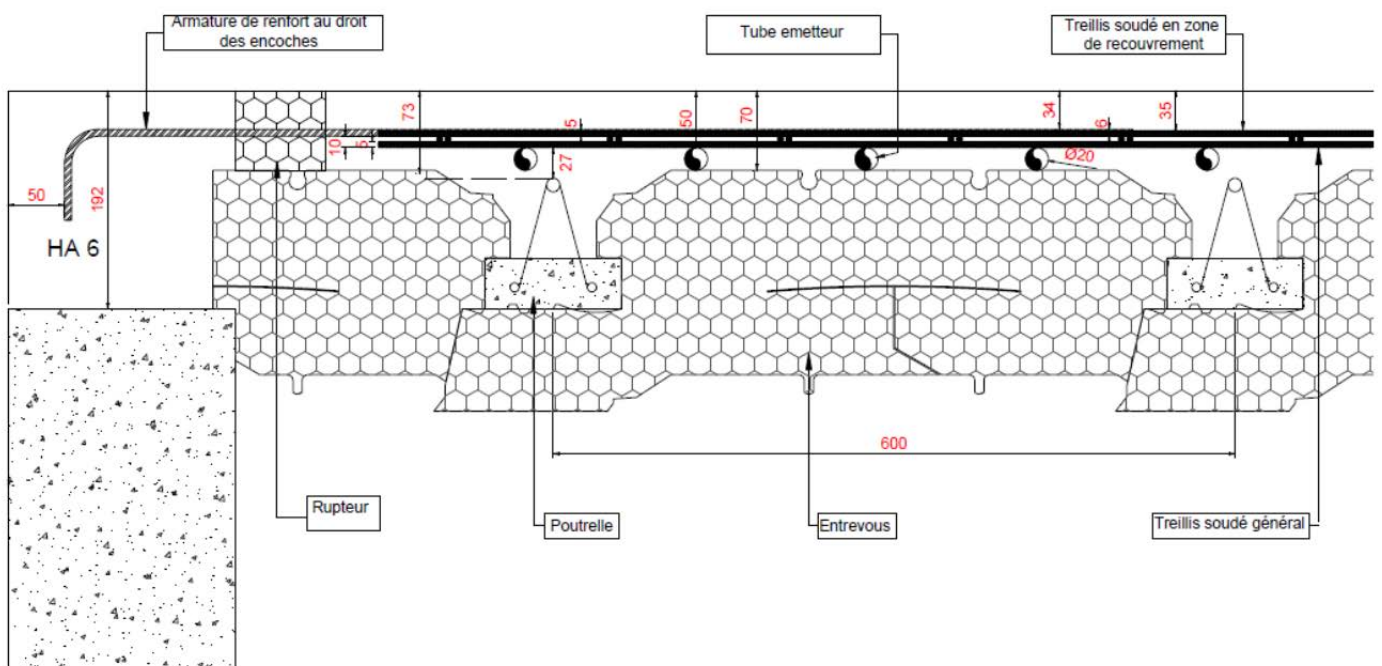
Coupe sur plancher avec tubes de 20mm et table de compression standard de 70mm
